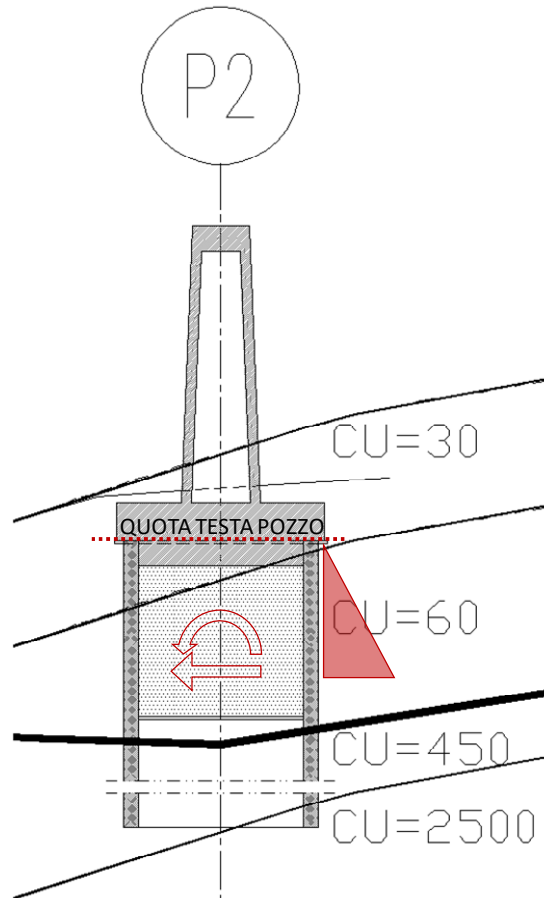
Schema applicazione della spinta delle coltri instabili al pozzo di fondazione
